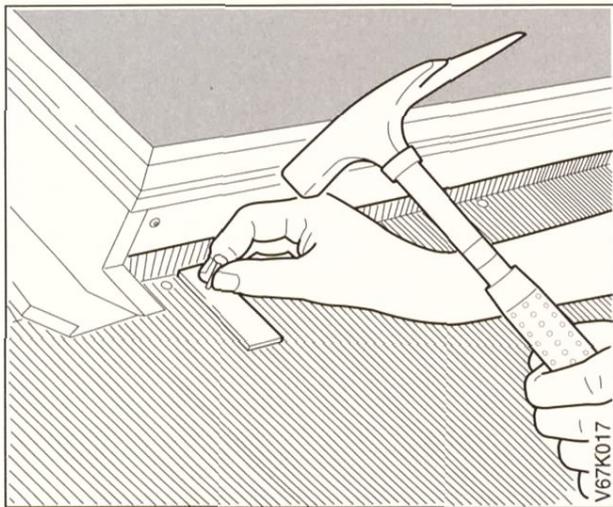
Auf der Bleischürze 3 Blechlaschen pro Kollektor möglichst weit oben befestigen.
